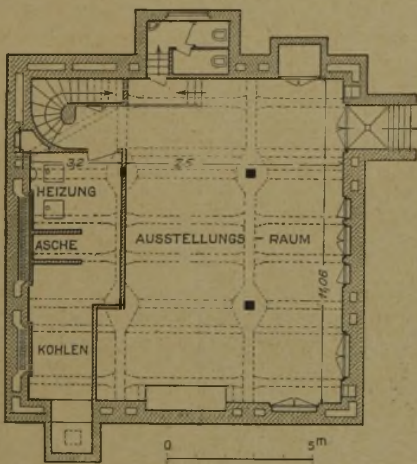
(Mitte). Grundrisse vom Keller, Erd- und Obergeschoß. (1 : 250.)
